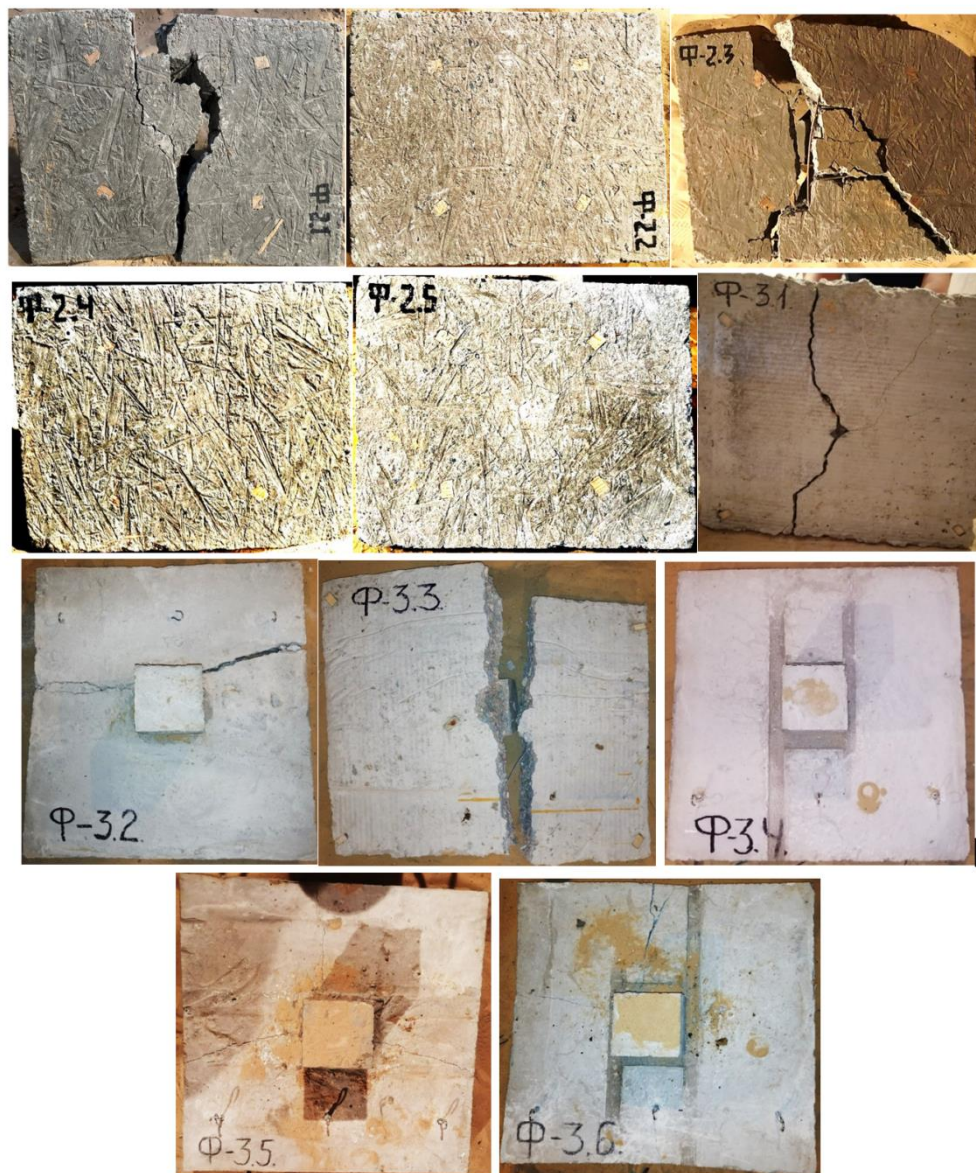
Разрушение железобетонных моделей фундаментов
